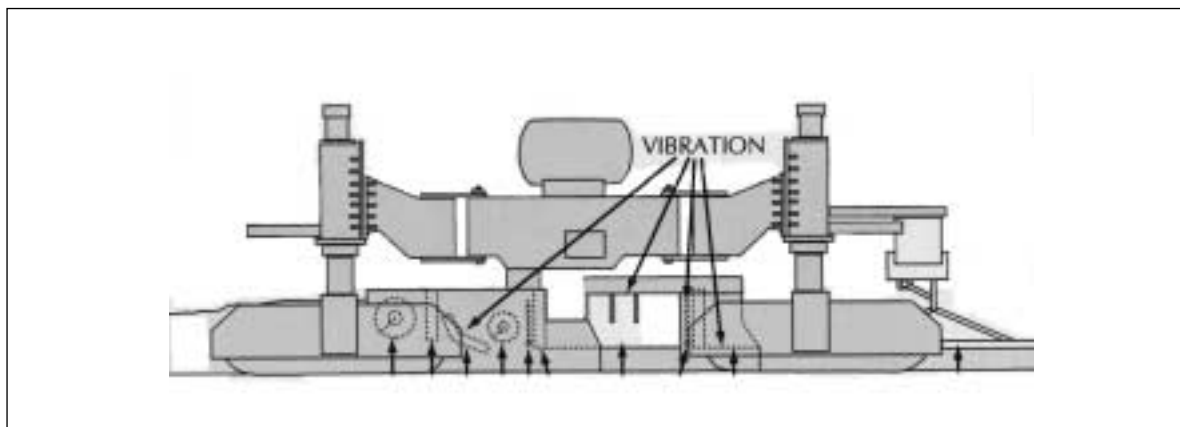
Rozdělovač betonu pro druhou vrstvu finišerem Wirtgen SP 1600.
